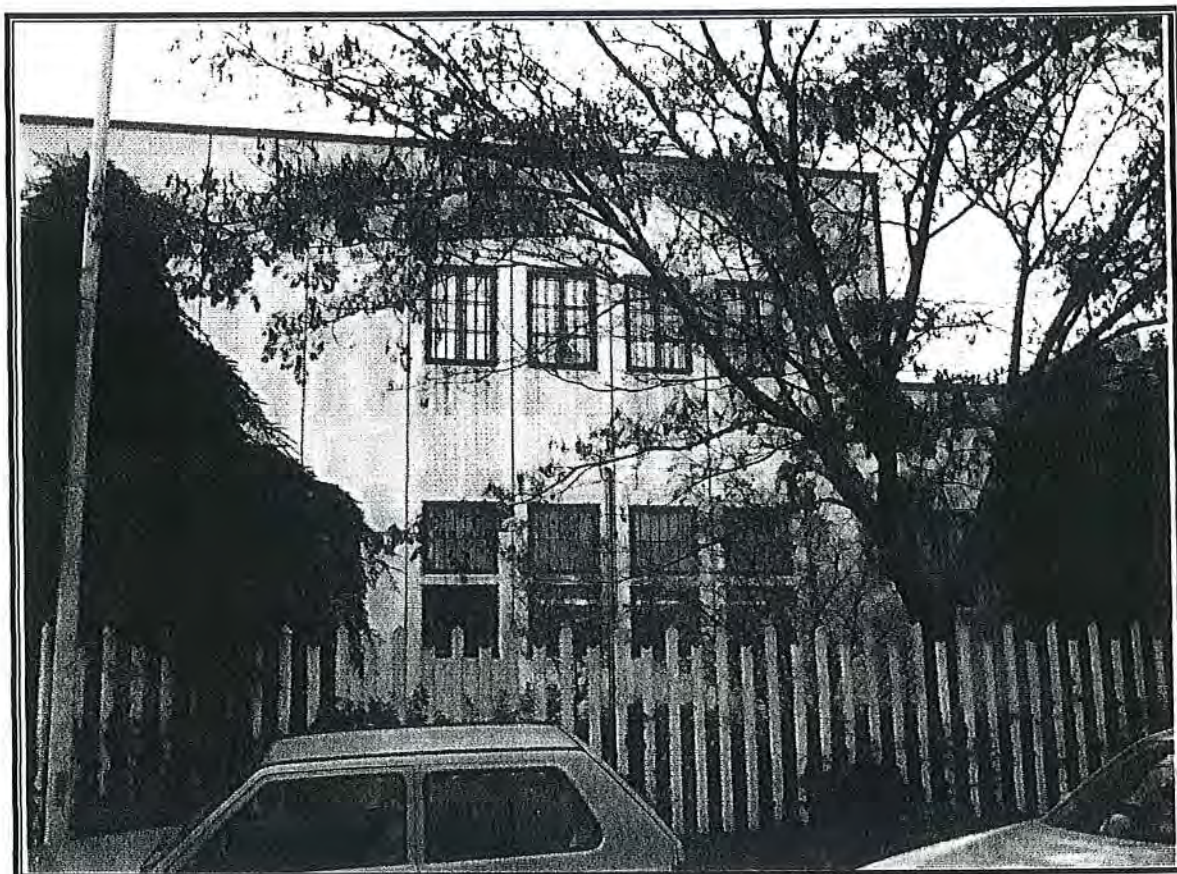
Particolare del prospetto su strada dell'edificio in oggetto
